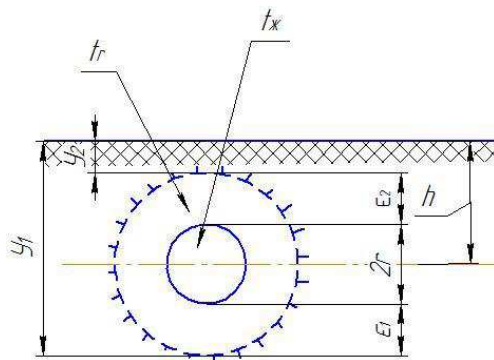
Подземная труба (стальная) без теплоизоляции.
